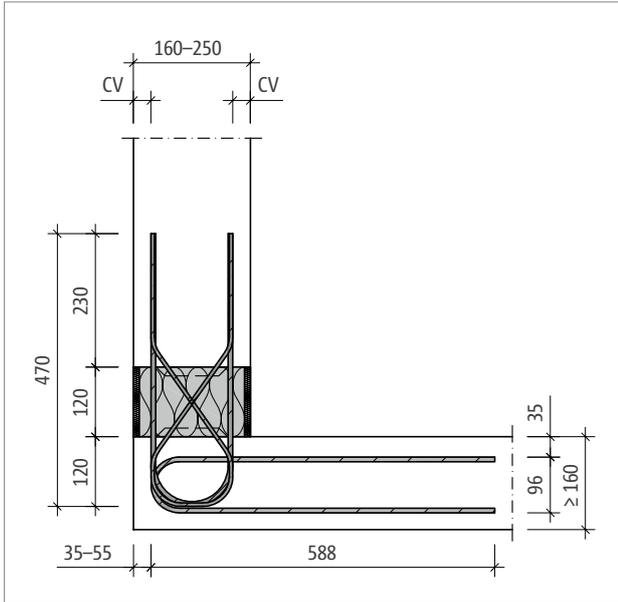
Schöck Isokorb® XT Typ A-MM1: Produktschnitt
